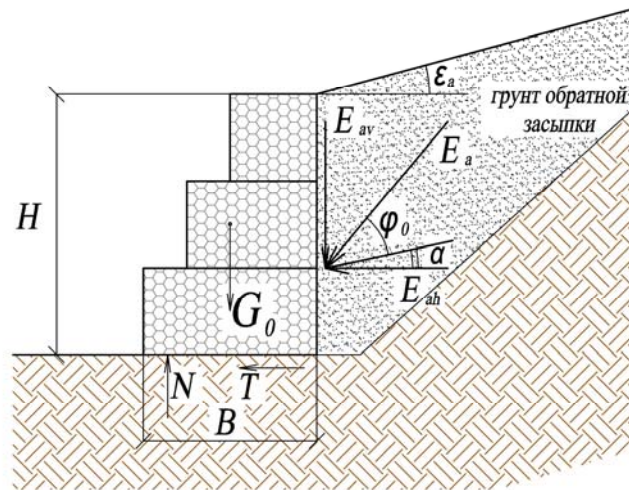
Схема к расчету устойчивости подпорной стены из габрионных конструкций на сдвиг
